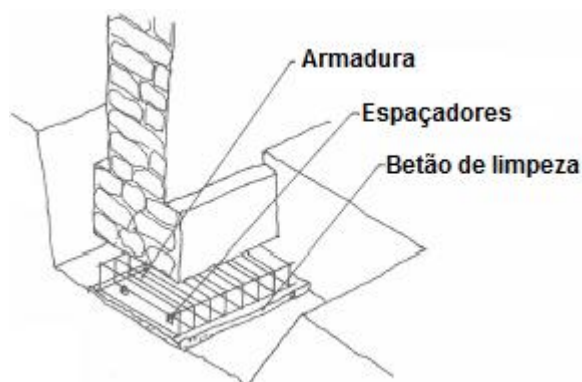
Execução do betão de limpeza e da armadura do recalce [55]
